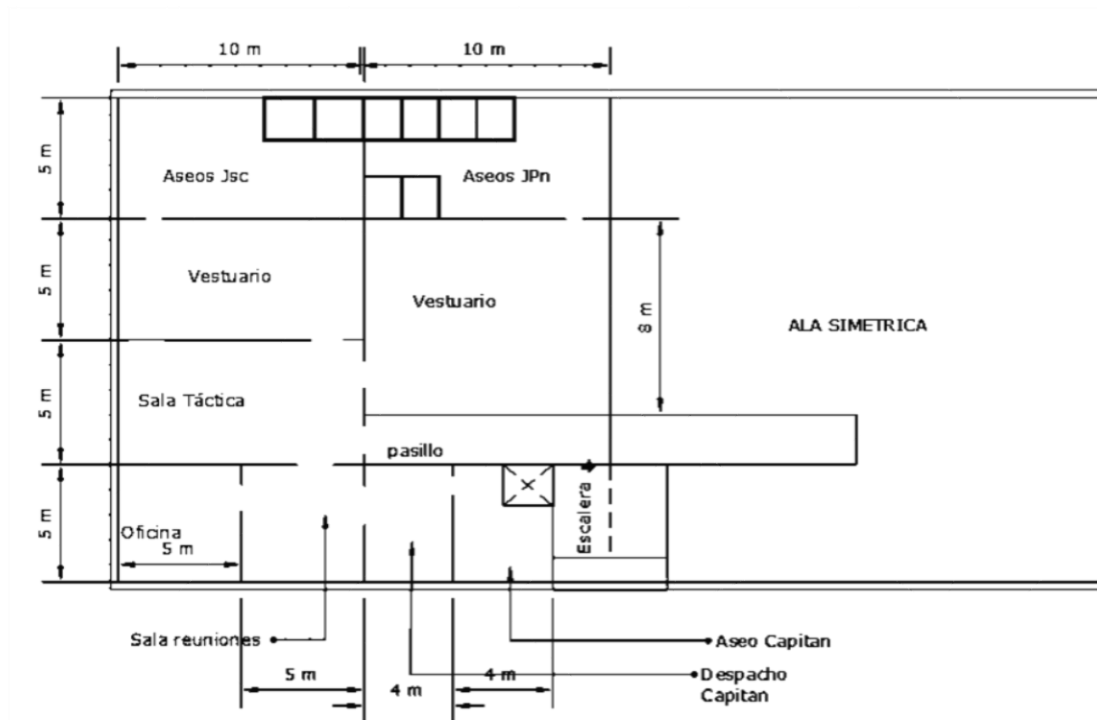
Plano planta 0. Fuente: Elaboración propia.
